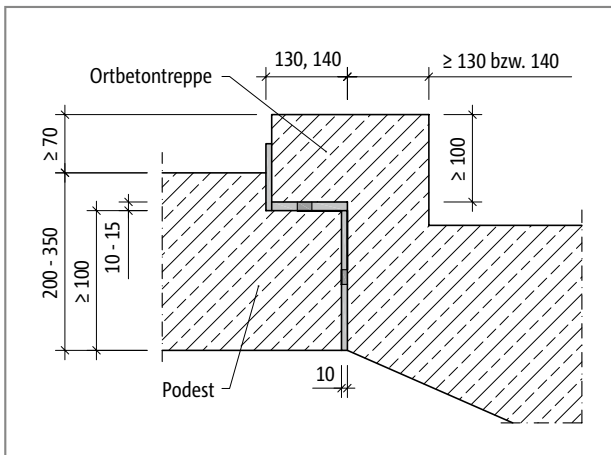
Schöck Tronsole® Typ BZ: Ausführungsvariante Auflagerung eines Ortbetontreppenlaufs am Podestrand mit Konsolausbildung
